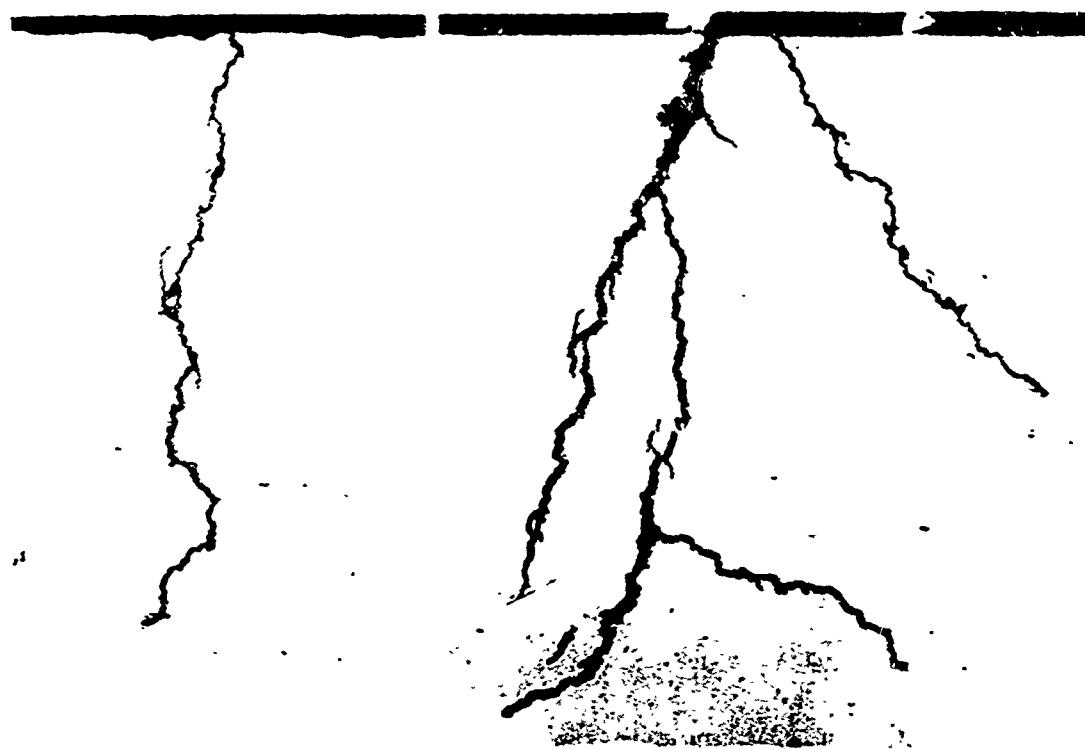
Detalhes de fissuras da figura anterior.
